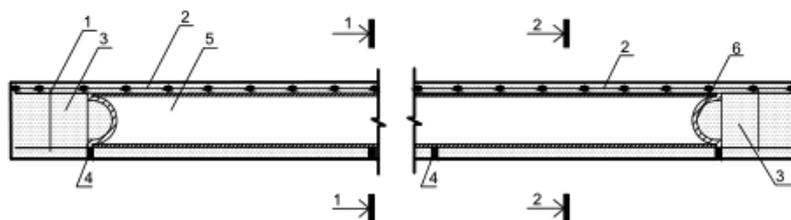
Продольный разрез плиты: 1-вертикальный арматурный каркас; 2 – верхняя горизонтальная сетка арматуры; 3-монолитный бетон; 4 - подкладка; 5 – труба-пустотообразователь; 6 –заглушки
